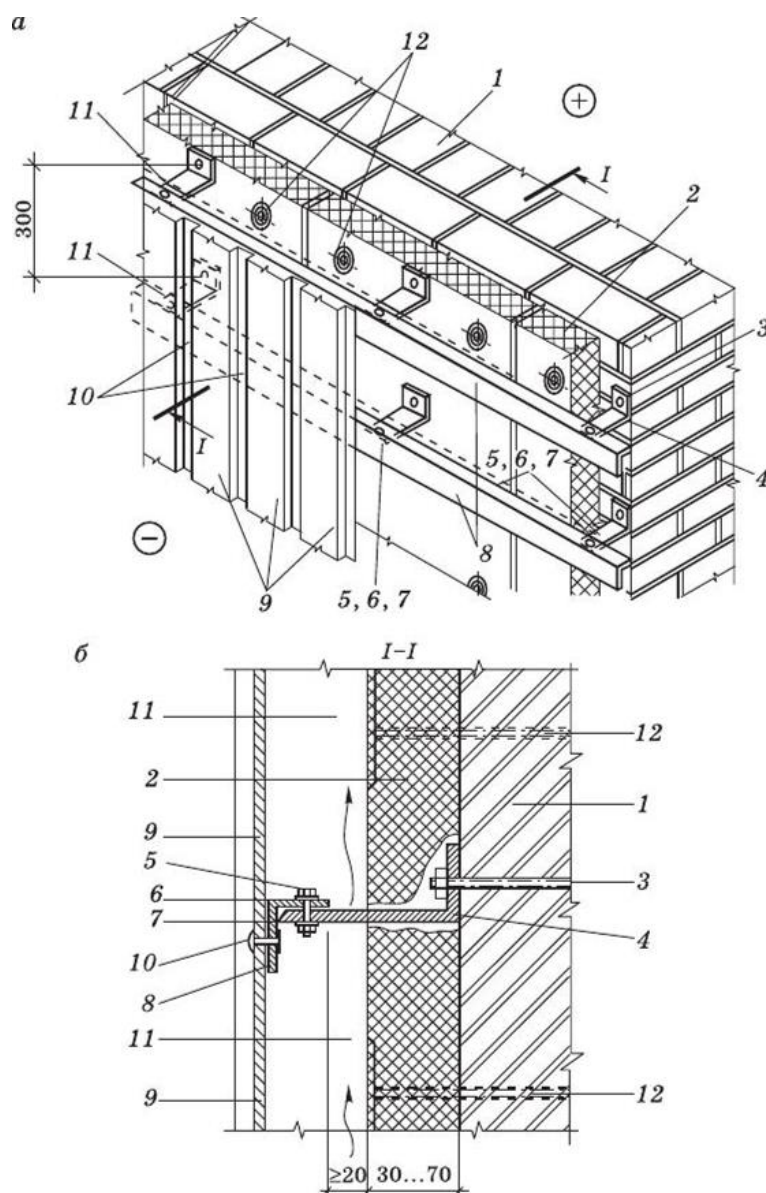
Наружная теплоизоляция стен здания «вентилируемый фасад»:
